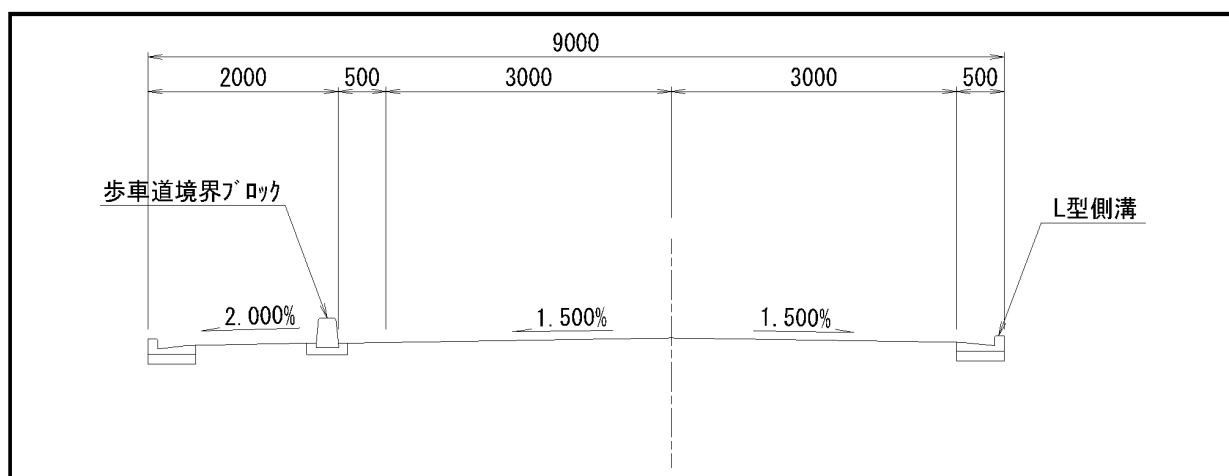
(5) 道路の標準断面図（区画道路 9-1 号線 幅員 9.0m）
